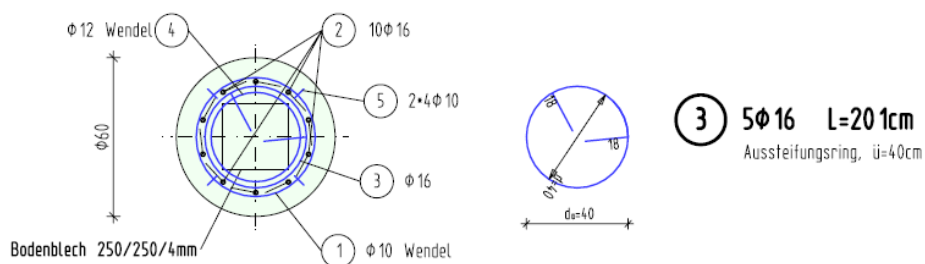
Regelbewehrung Ortbetonbohrpfähle
